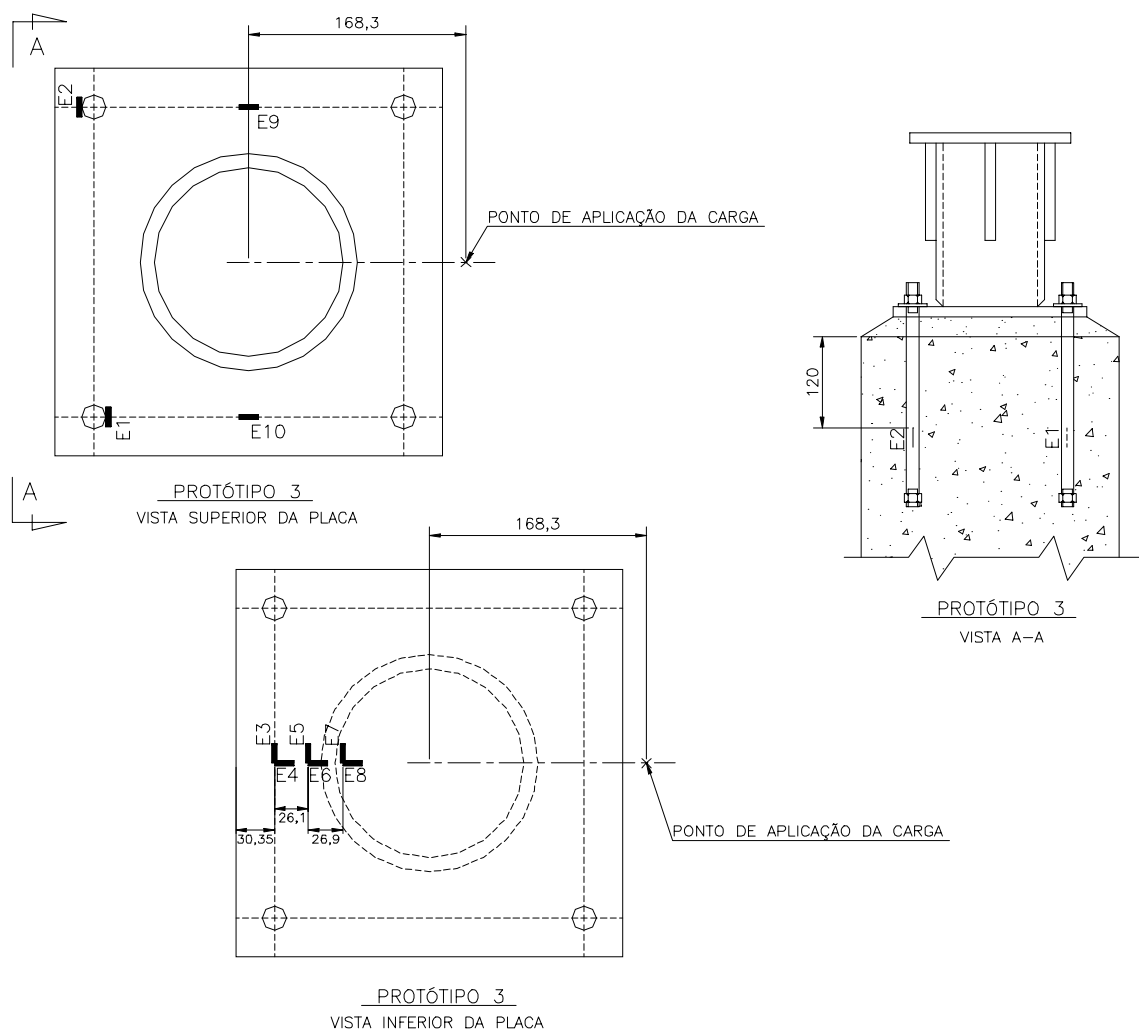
Detalhe do esquema de instrumentação com extensometria utilizado no Ensaio 4.
